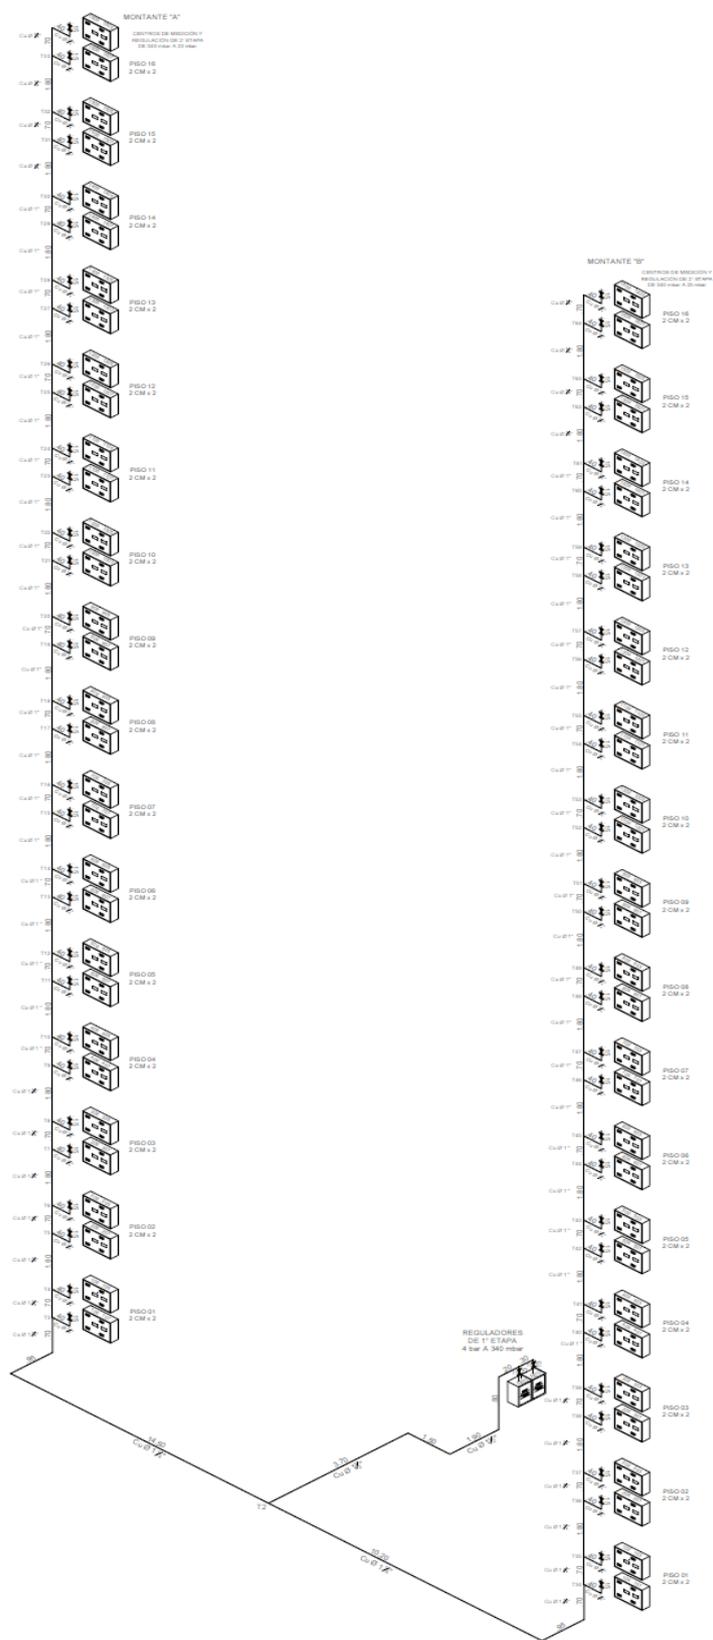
Vista isométrica de montante de Instalaciones de Gas
